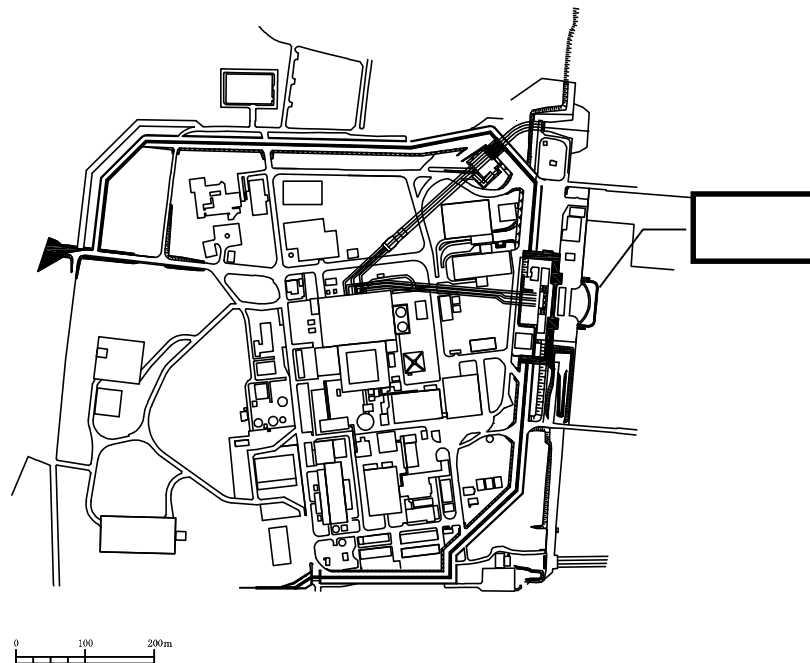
(1) 貯留堰 平面配置図 (全体図)
